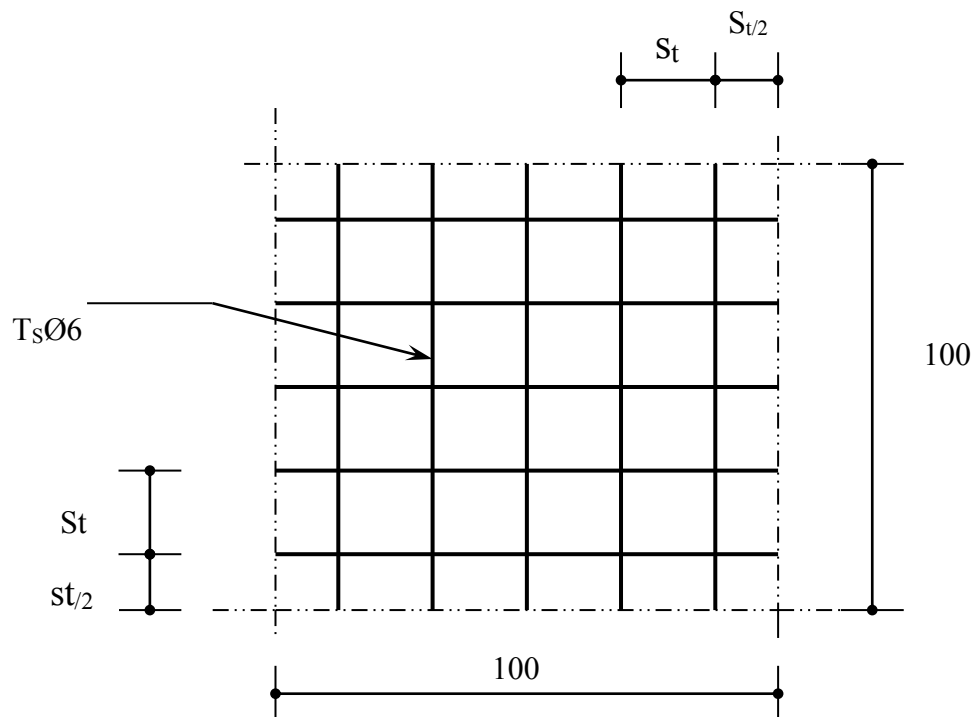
Disposition constructive des armatures de la dalle de compression.
